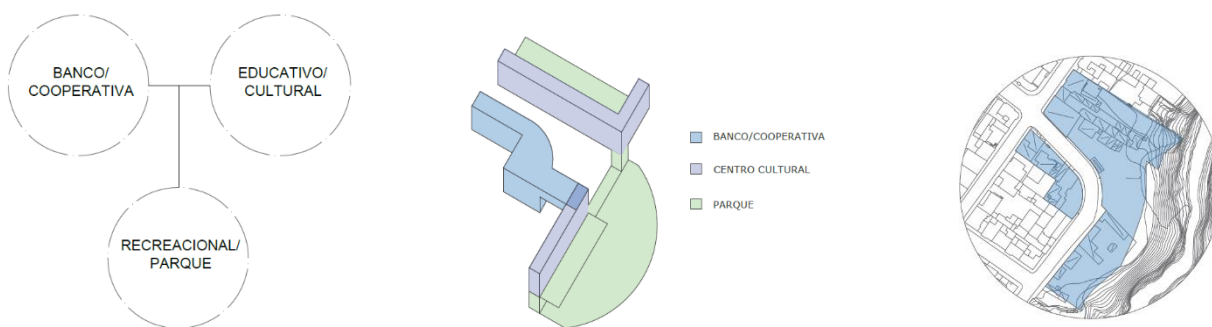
Diagramas plan arquitectónico. (elaboración propia)
